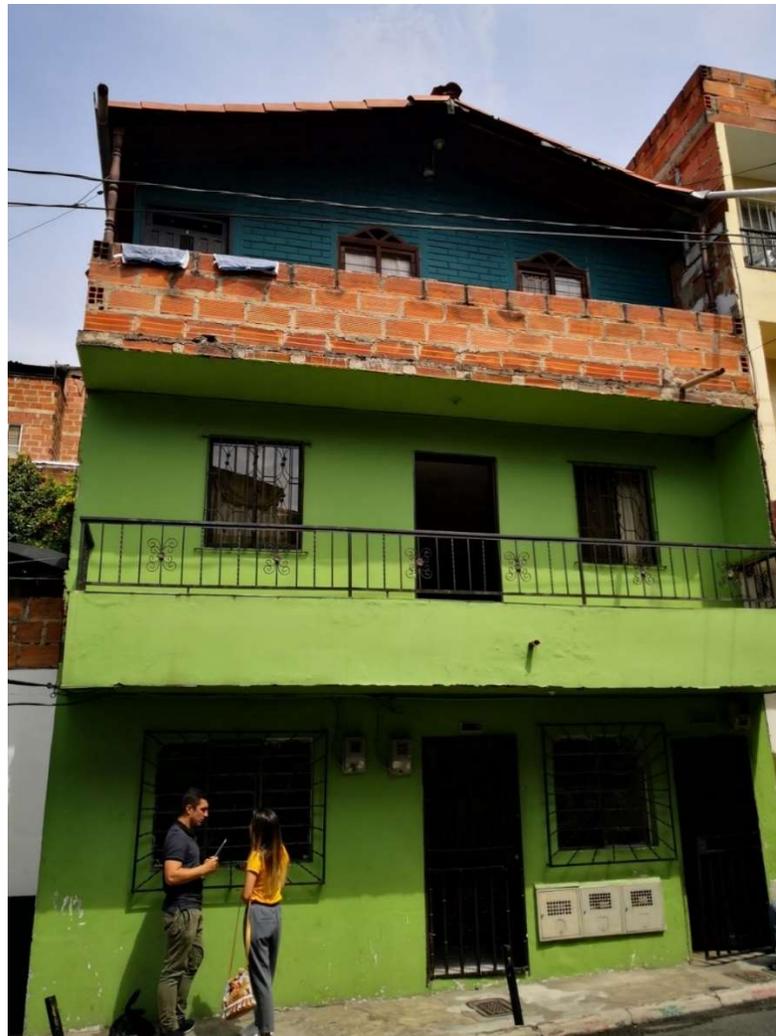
Fachada de la vivienda de estudio. Fuente: elaboración propia
